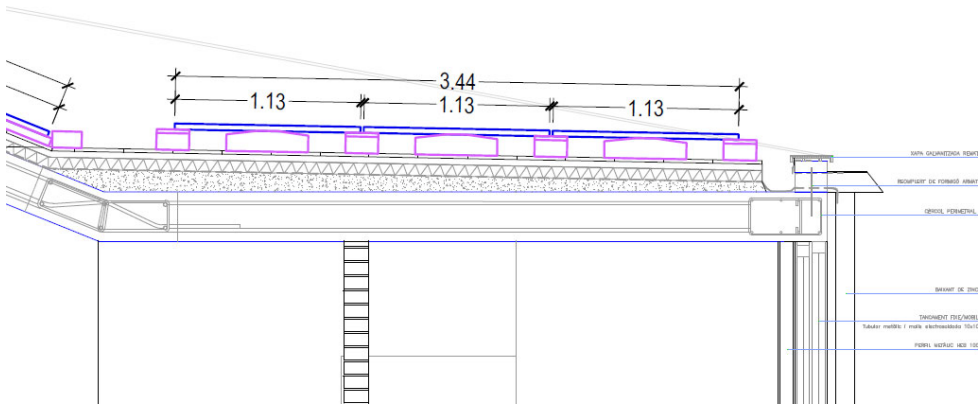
Estructura dels mòduls fotovoltaics en la part plana de la coberta
